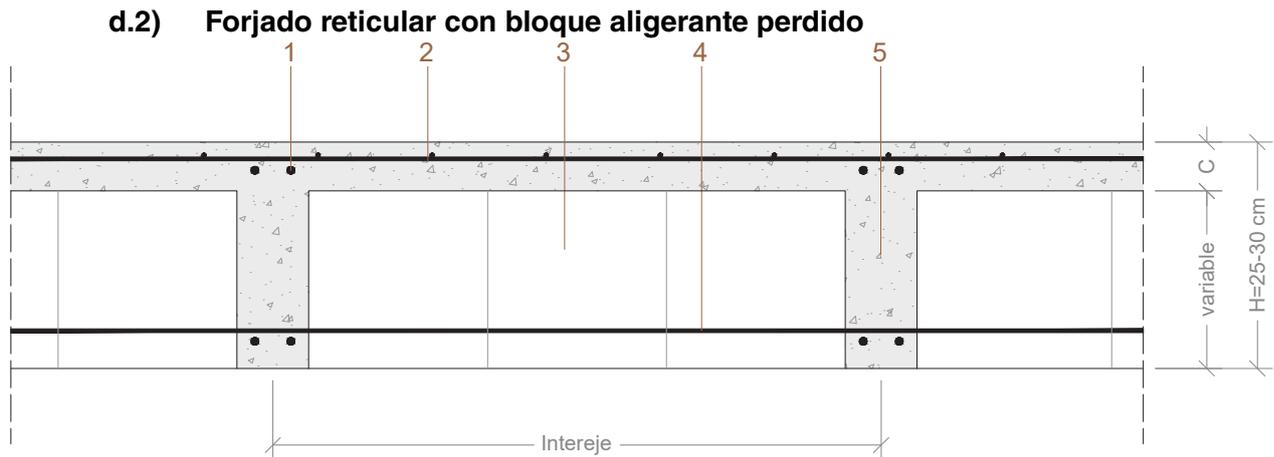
Sección tipo de forjado reticular con bloque aligerante perdido
